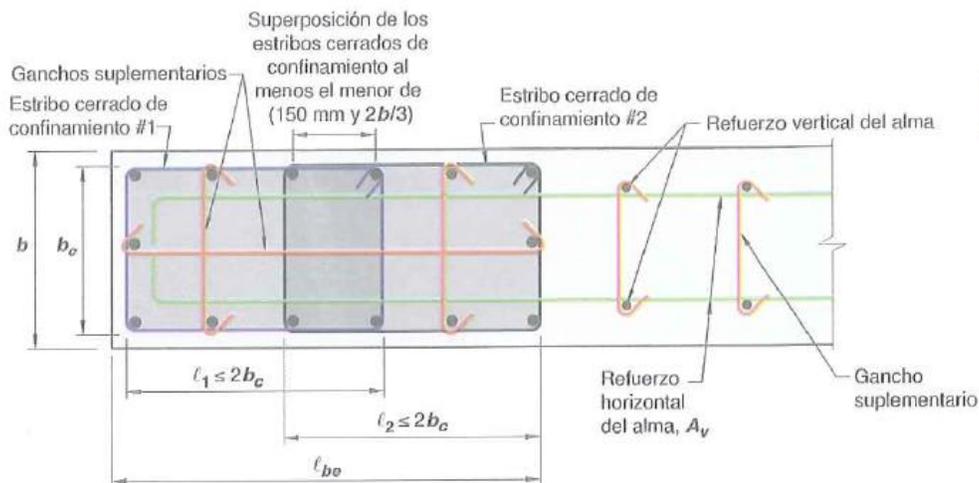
Cuantía de refuerzo longitudinal para condiciones típicas de borde en el muro (AIS, 2010)
